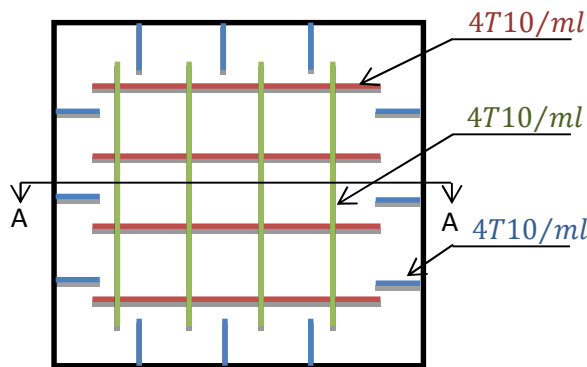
Schéma de ferrailage de la dalle au-dessous de l'ascenseur.
